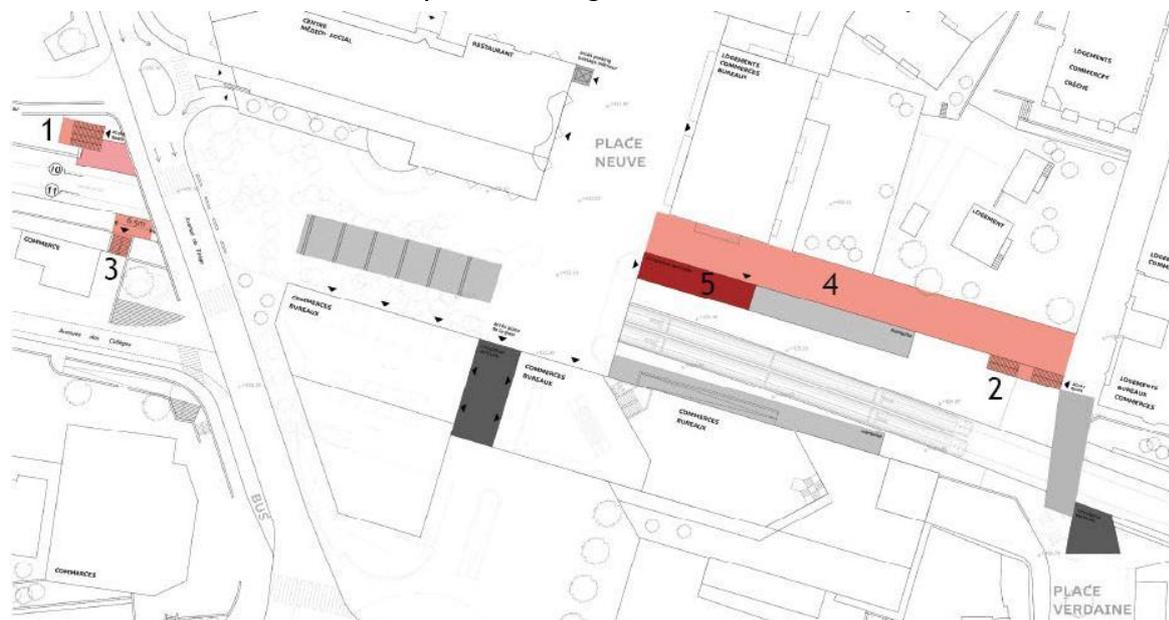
Plan des ouvrages de la phase 1 des travaux
